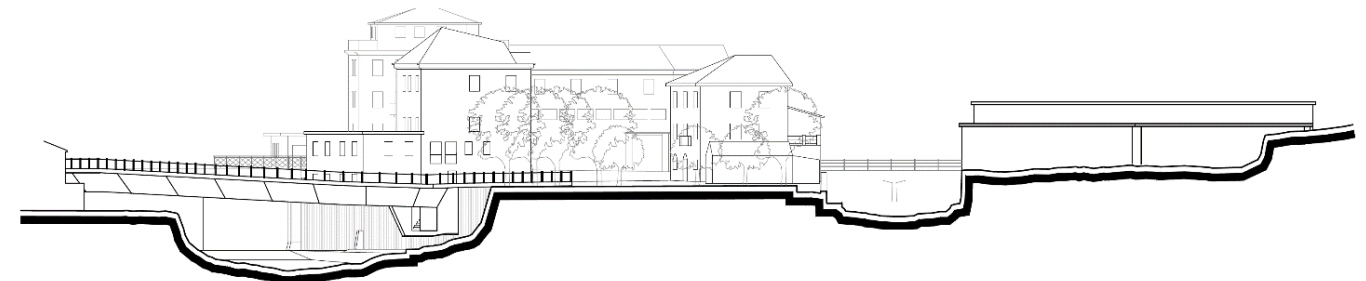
Sezione di progetto trasversale ai torrenti Burba e Molinassi nel nodo di Geo
